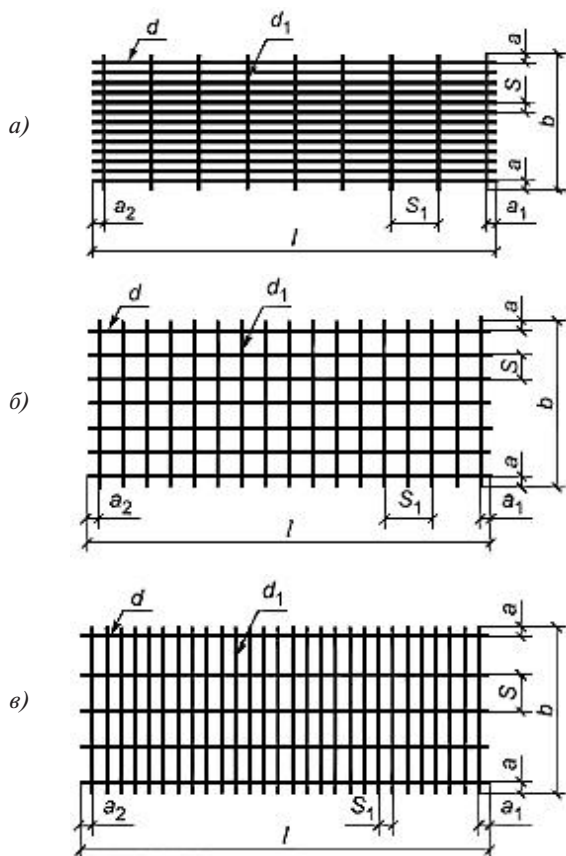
Тяжелые арматурные сетки: а – тип 1; б – тип 2; в – тип 3
